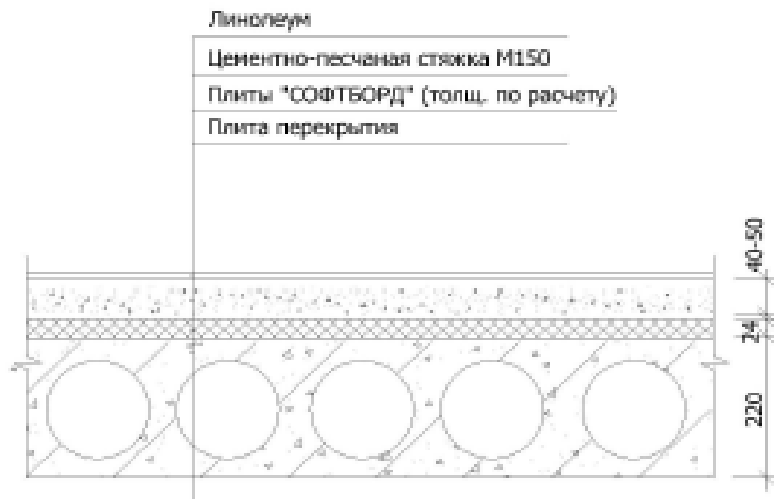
Применение плит СОФТБОРД в полах незадуваемого перекрытия
